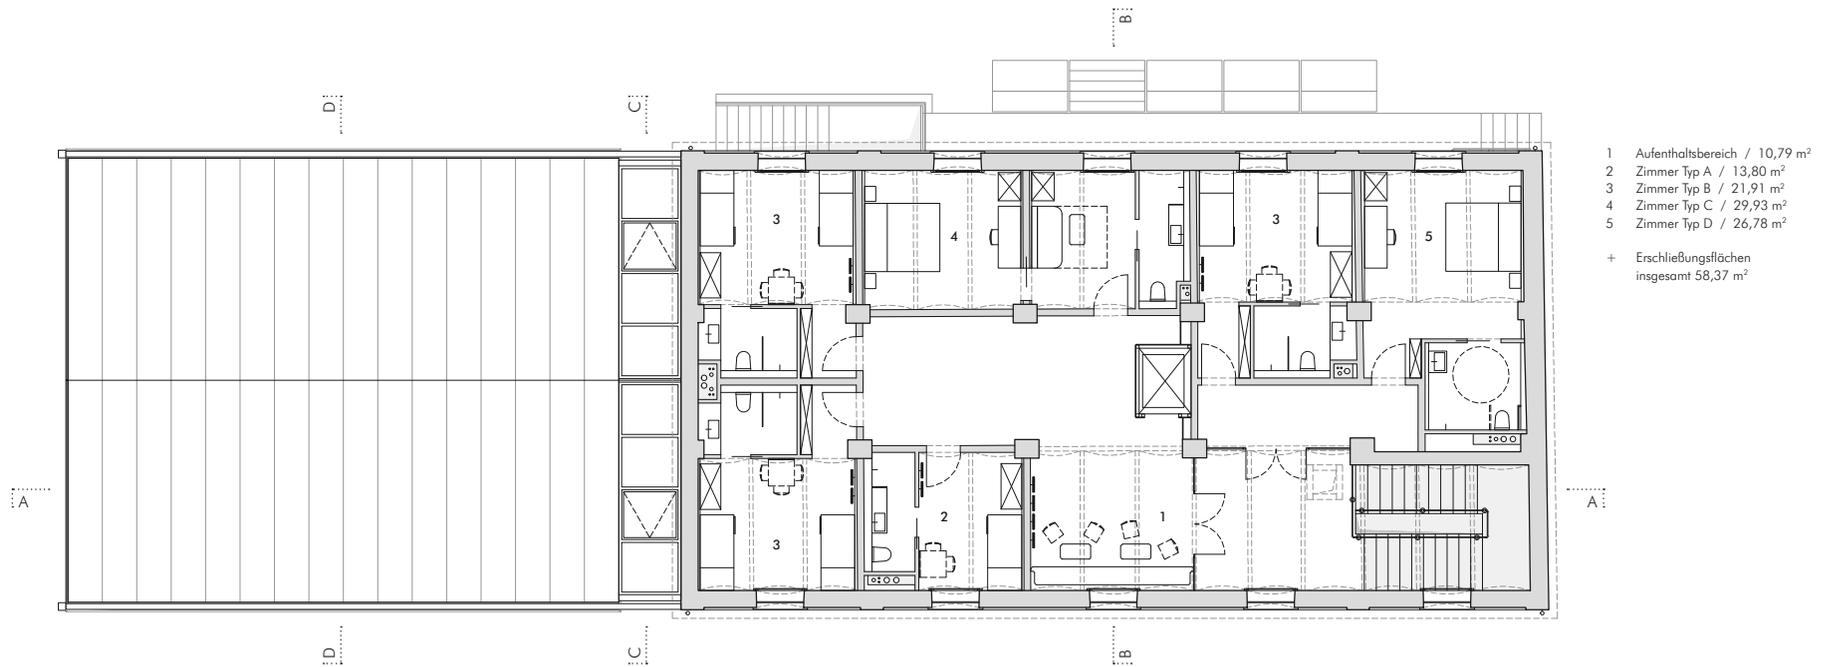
Grundriss 2. Obergeschoß, Entwurf, M 1:200
